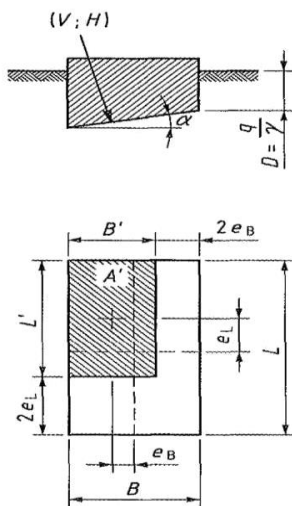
Расчетная схема для определения несущей способности основания плитного фундамента по методике Eurocode 7 аналитическим методом с использованием рекомендуемого приложения D /5/
